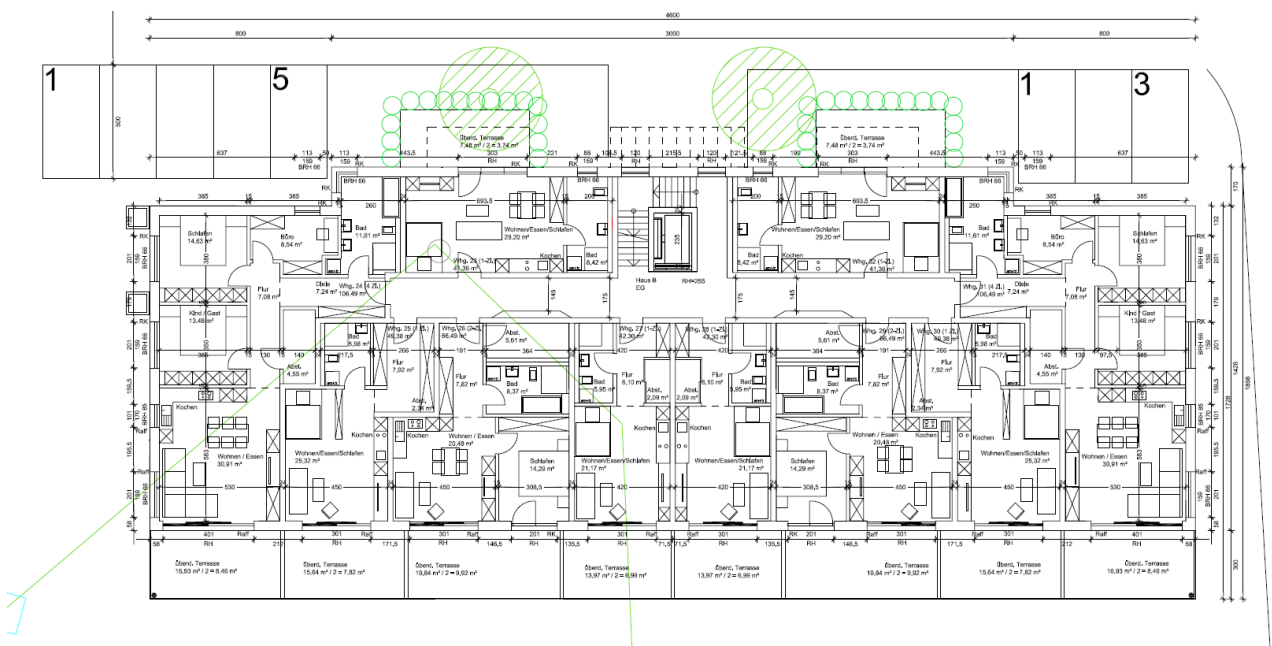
Vorhaben Grundriss Erdgeschoss Gebäude 1 [12]
